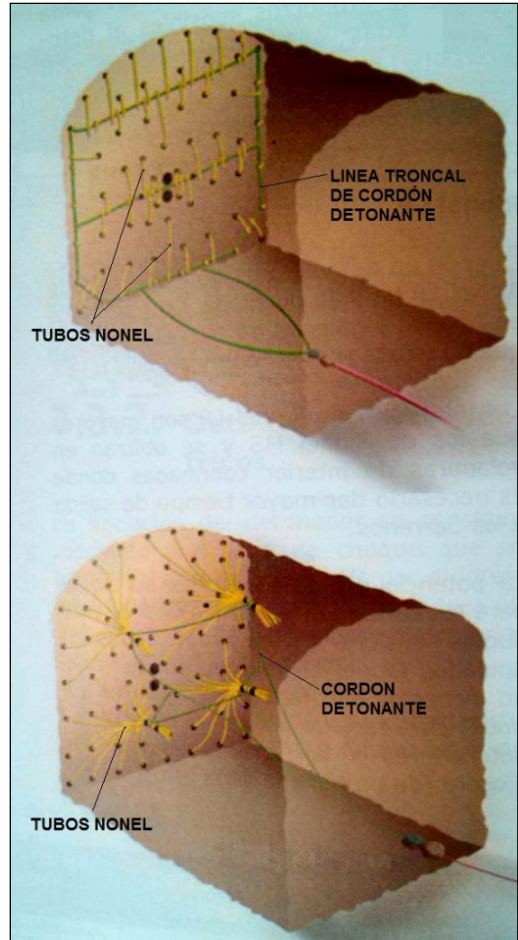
Tipos de conexiones utilizando nonel. [60] López Jimeno (2011).
